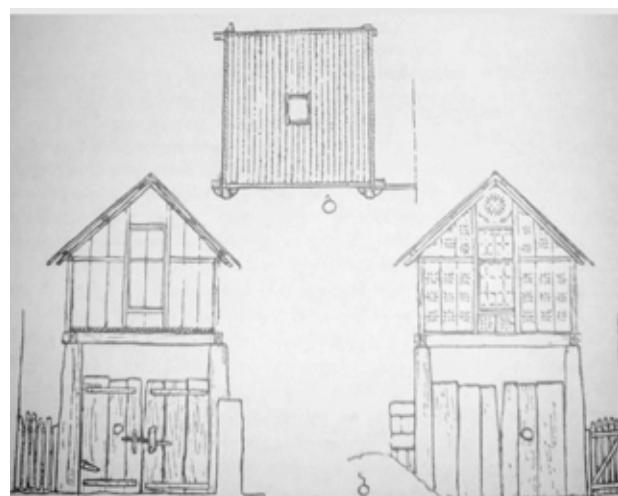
Almacenamiento de maíz (sección transversal, fachada y planta) pueblo de Sasashi, Kvemo Svaneti.
